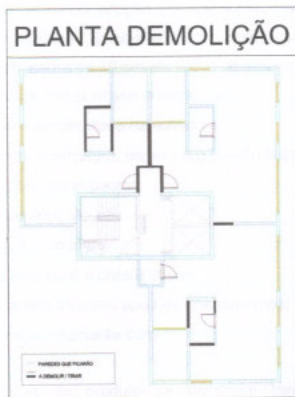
Planta Demolição do Projeto Wilsinski (Fonte: Autor)
